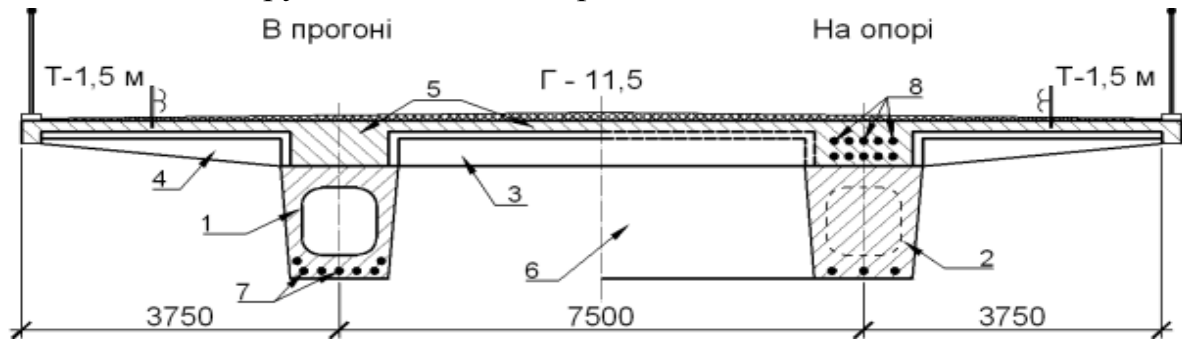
Поперечний переріз запропонованої залізобетонної прогонової будови мосту
